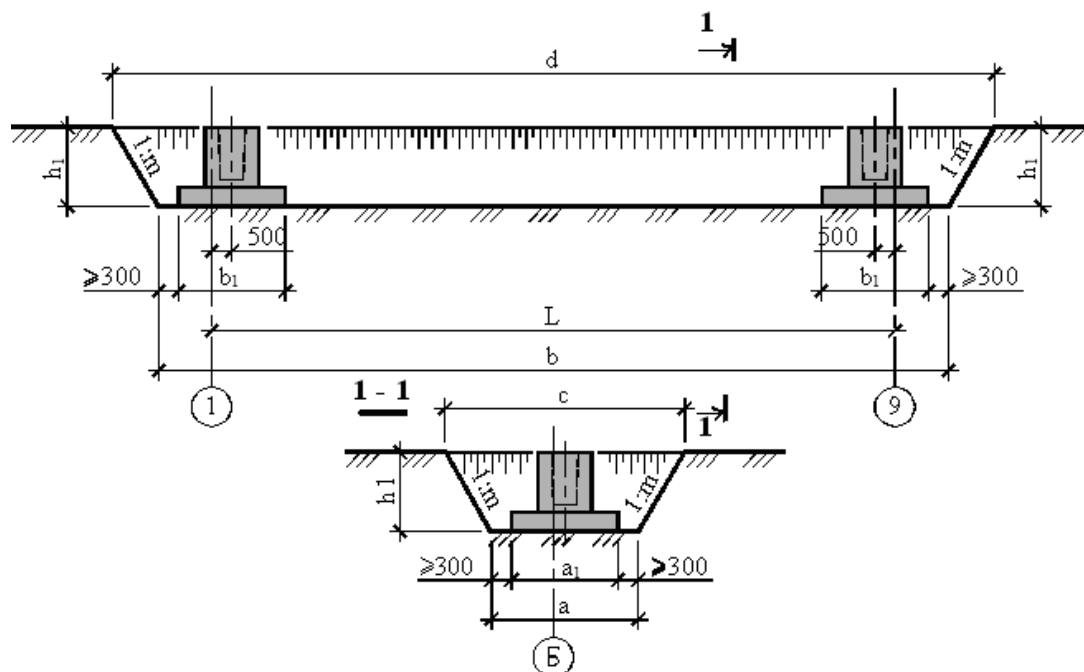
Схема расположения столбчатых фундаментов в прямоугольной траншее
